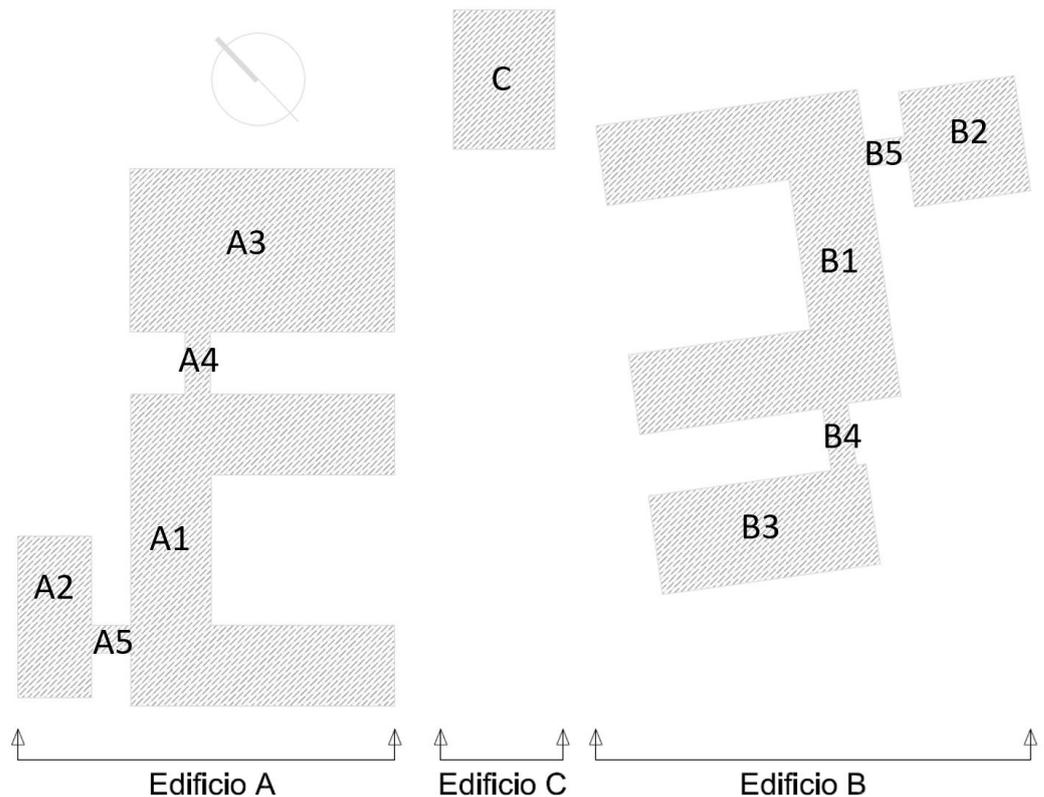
Planimetria con individuazione degli edifici del plesso scolastico
